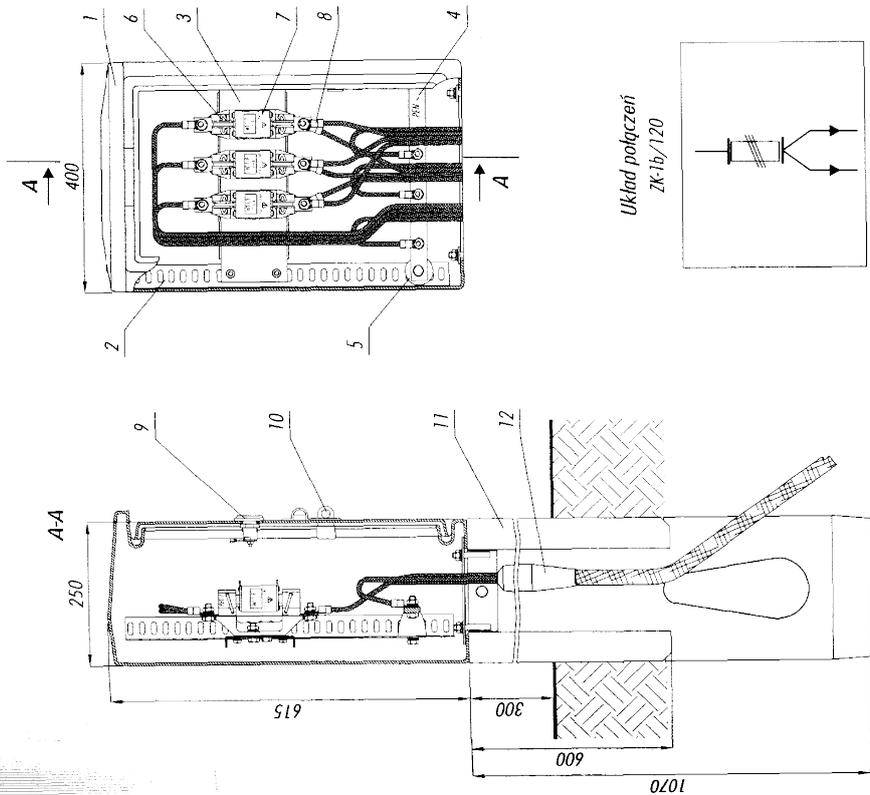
Połączenie instalacji elektrycznej budynku mieszkalnego z kablową siecią rozdzielczą: a) z mufą rozgałęźną; b) z przelotowym wprowadzeniem kabla do złącza
